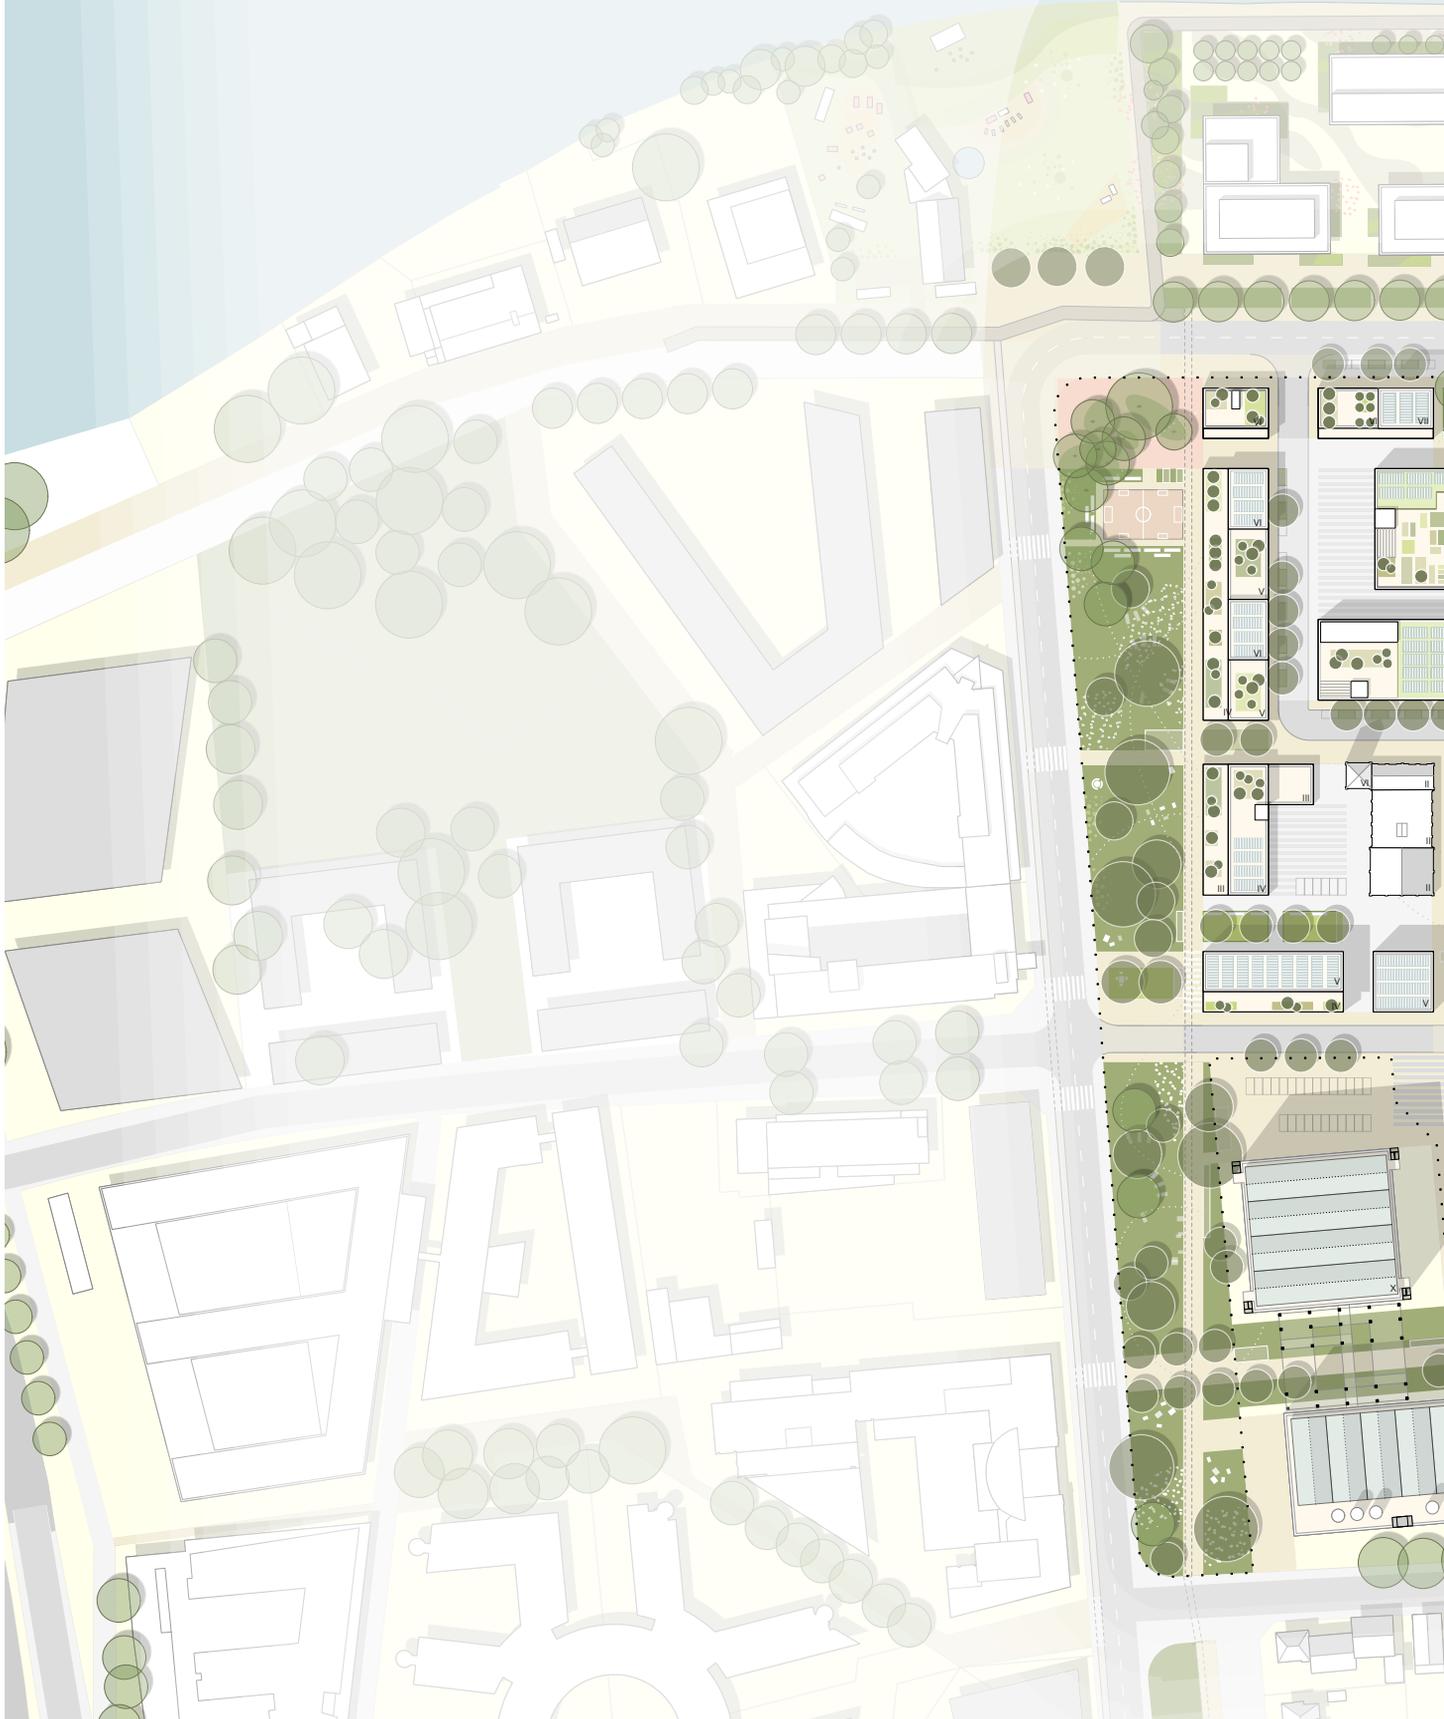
Verkleinerte Version des Rahmenplans (original im Maßstab 1:1000). Quelle: Johanna Moraweg
